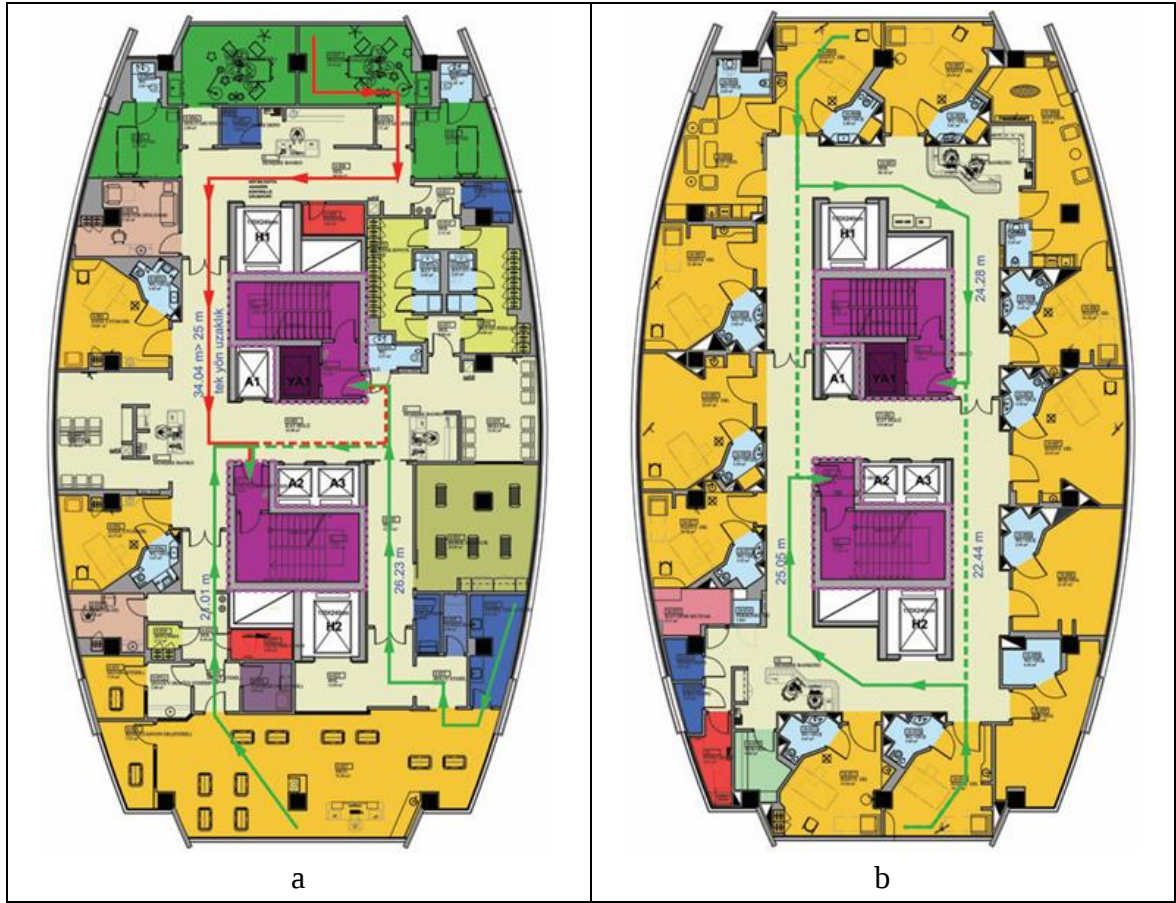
a. 3. Kat planı, b. 4. Kat planı
